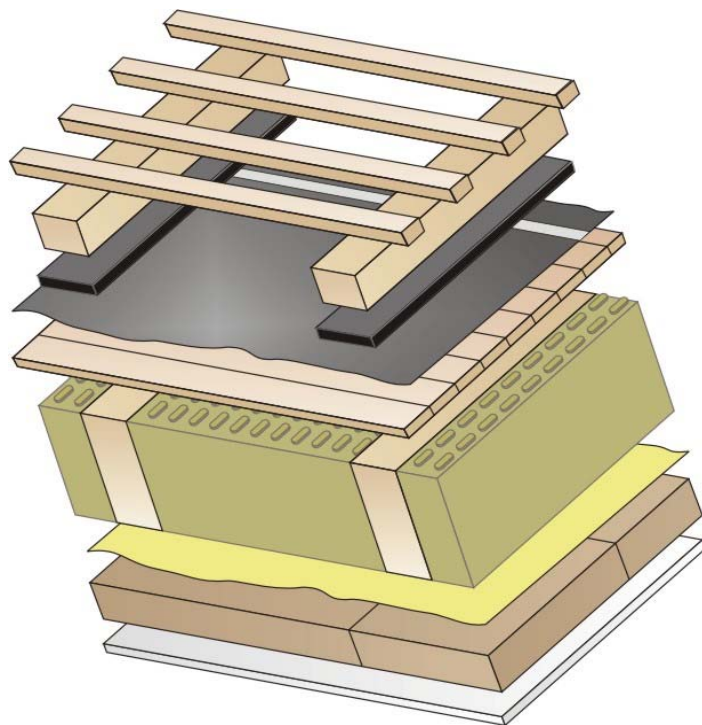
Grundrisschema einer Konterlattung mit Zusatzlatten, ohne schräg laufende Konterlatten
